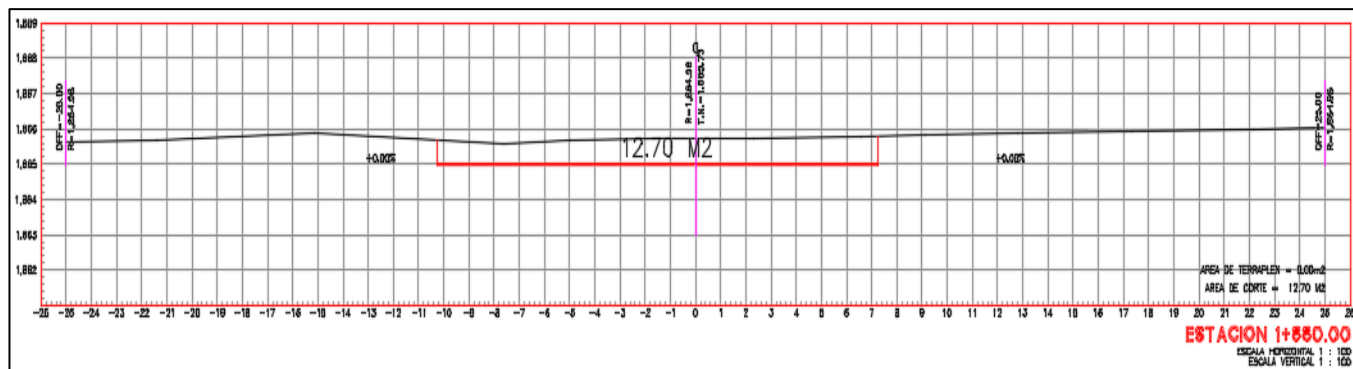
Sección transversal del cadenamiento 1+880 Banco La Estancia
